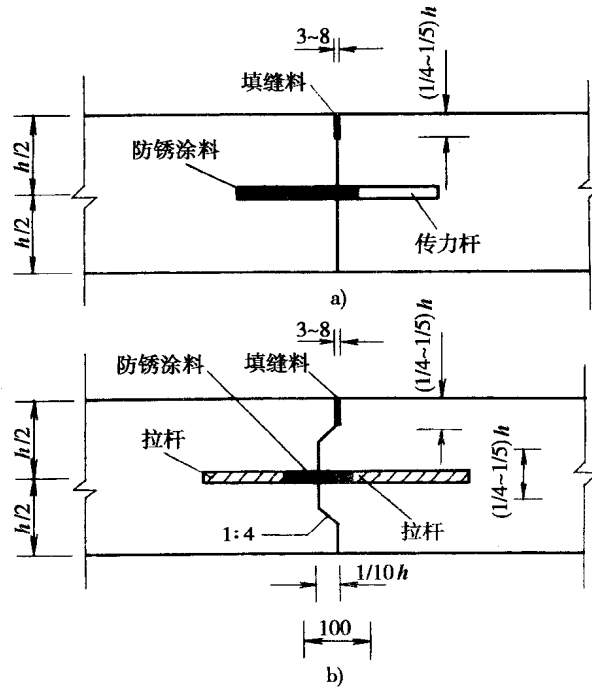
横向施工缝构造(尺寸单位:mm)
